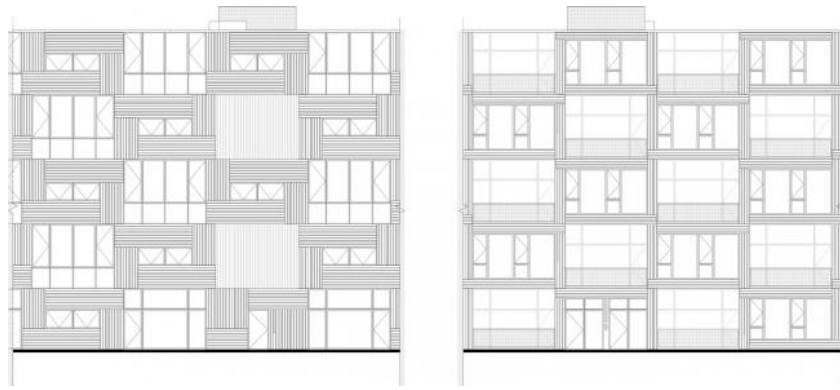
Фрагменти оздоблення фасаду [14]
